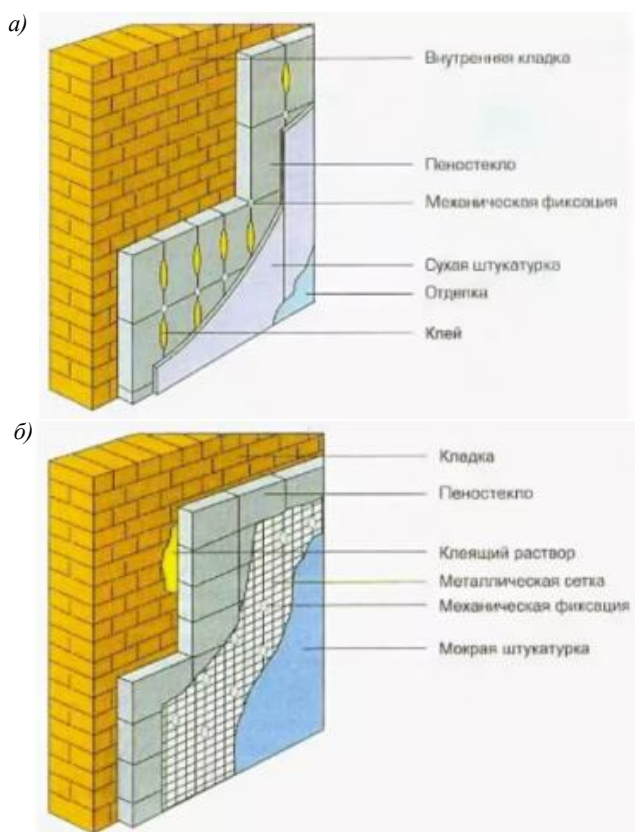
Варианты конструктивно-технологических решений утепления наружных стен зданий с постоянным пребыванием людей: *а* – утепление наружной стены здания блоками из пеностекла со стороны помещения; *б* – то же, с внешней стороны наружной стены здания
